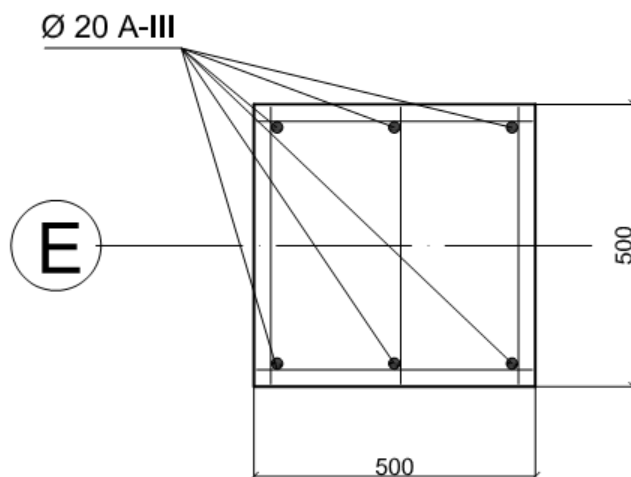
Схема армування збірних залізобетонних колон 500×500 мм крайнього ряду по осі «Е»
